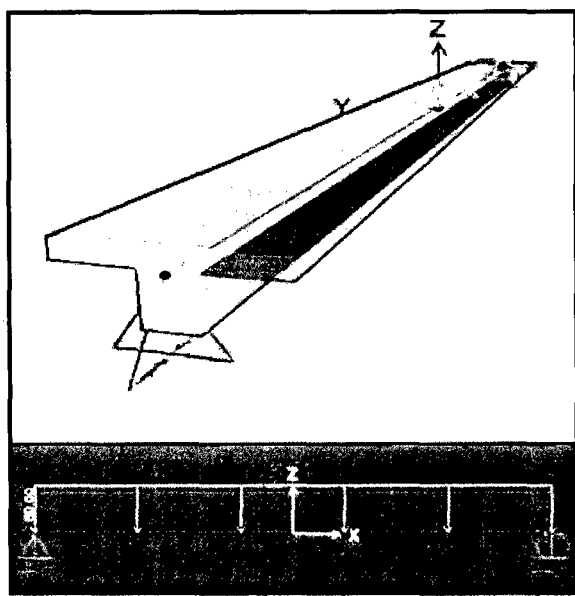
1: Vigueta de losa aligerada y carga viva (SAP2000).
